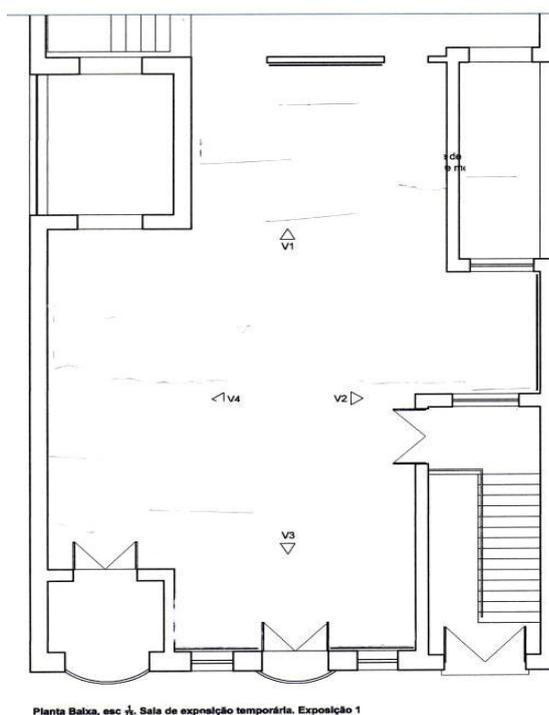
Planta baixa do espaço expositivo. Imagem do arquivo pessoal, planejamento expositivo de 2008.
